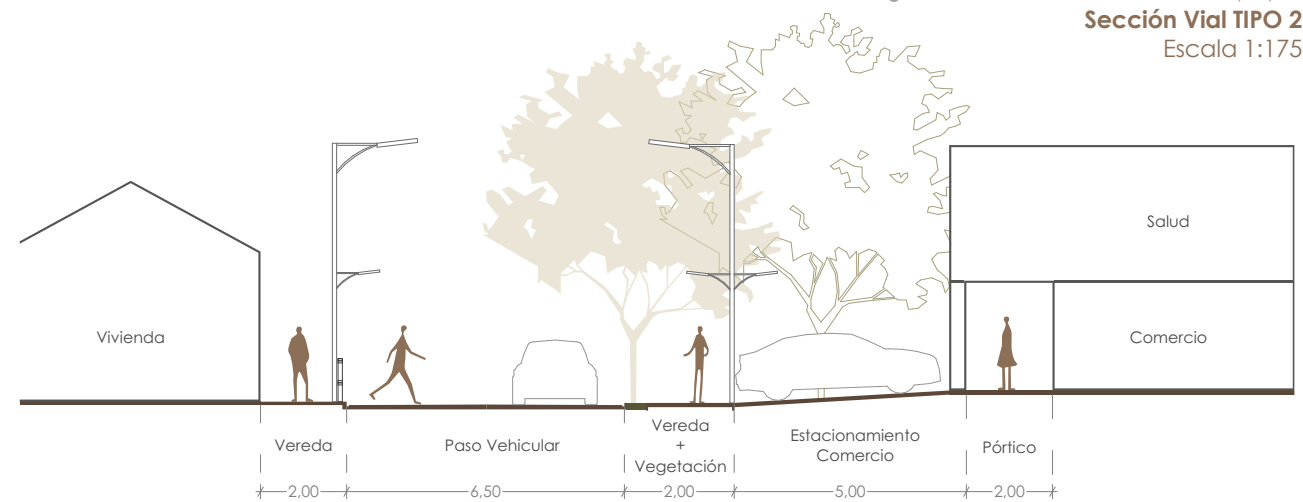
Sección vial T2. Fuente: Autoría propia.
